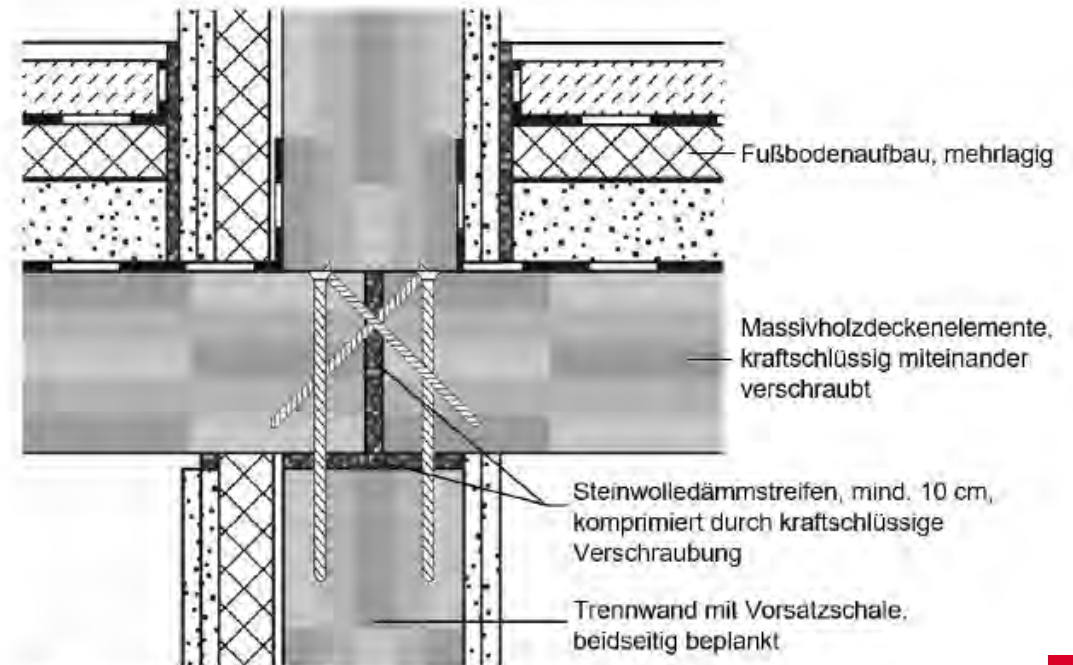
Bauteilanschluss Trennwand an Geschossdecke (Vertikalschnitt)
